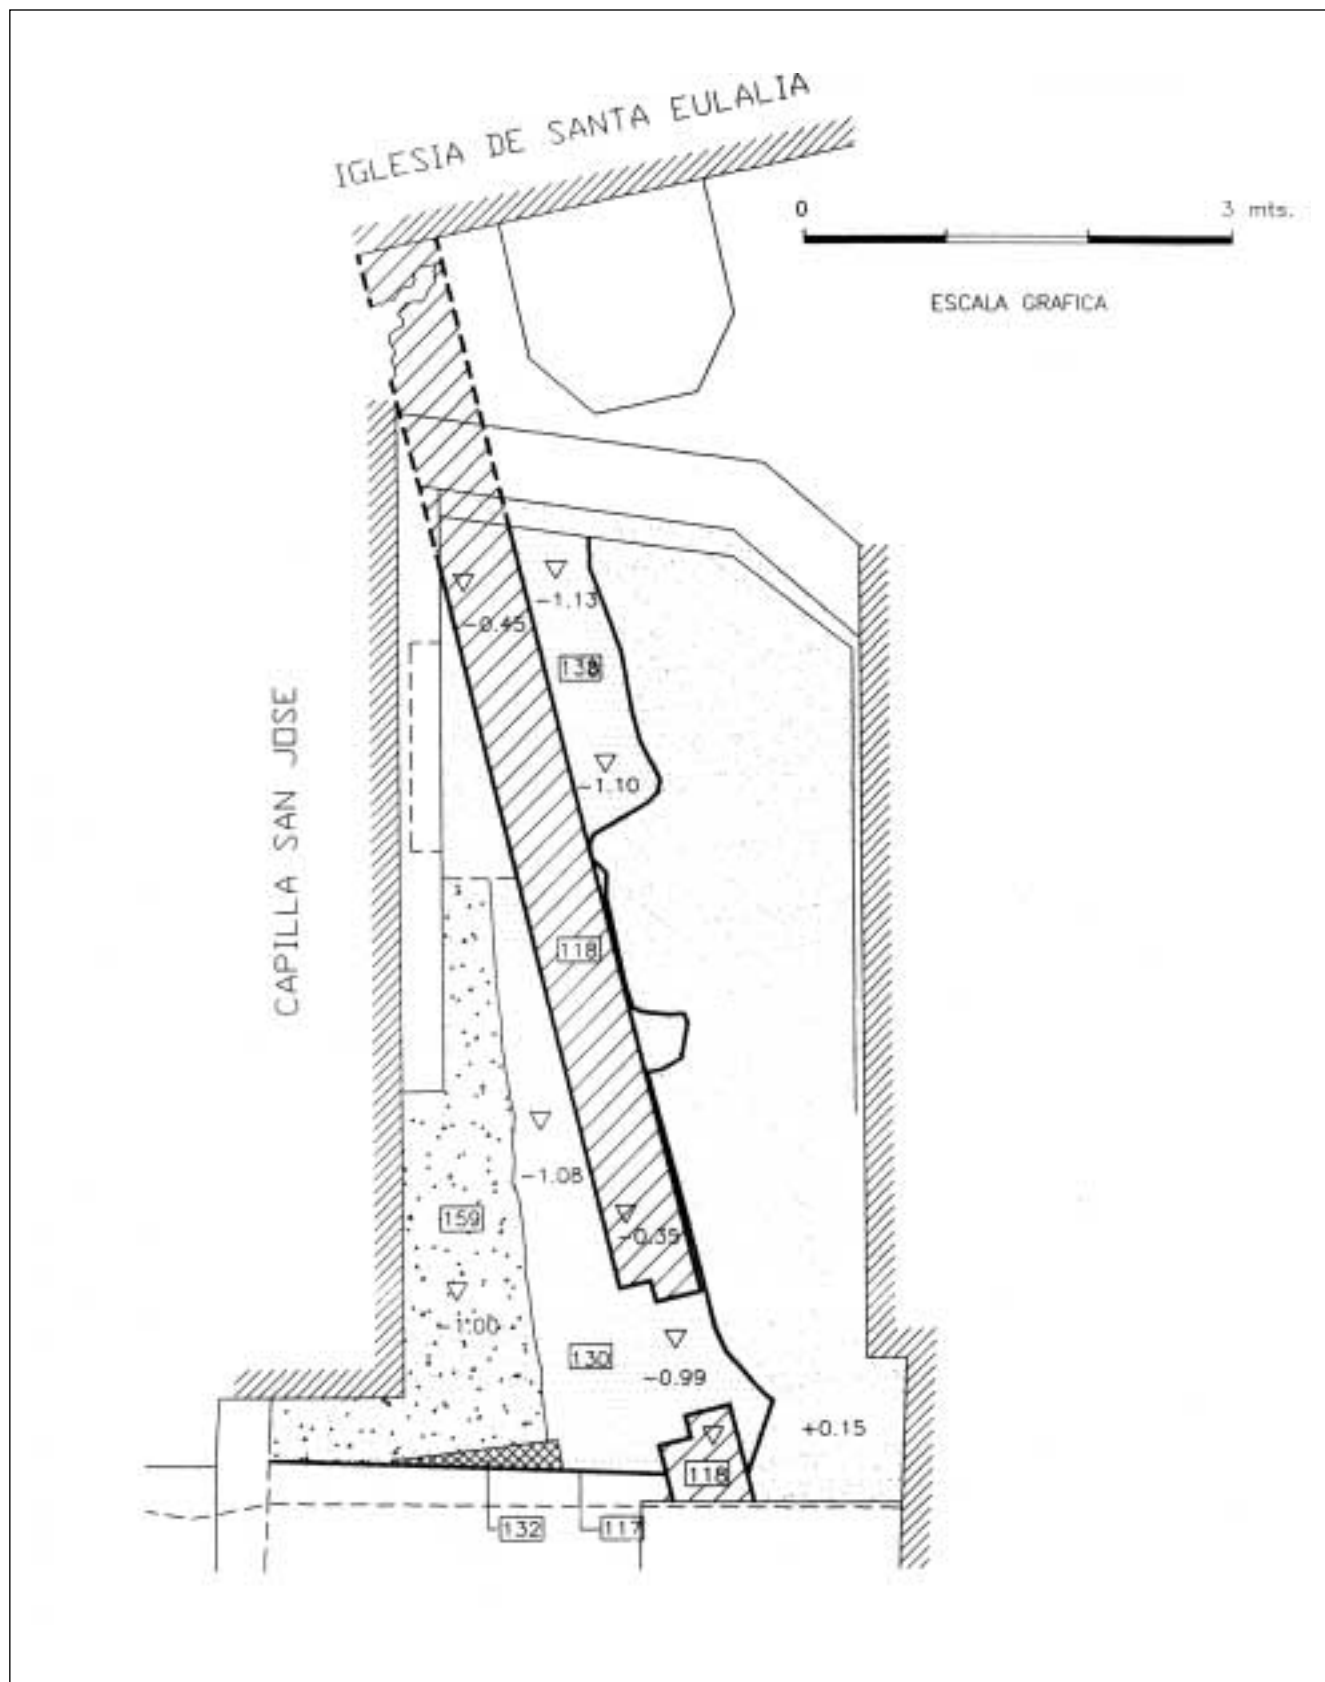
Planta de las estructuras de la ermita de San José (siglos XVI-XVII): muro 118 y suelos 130 y 138.
